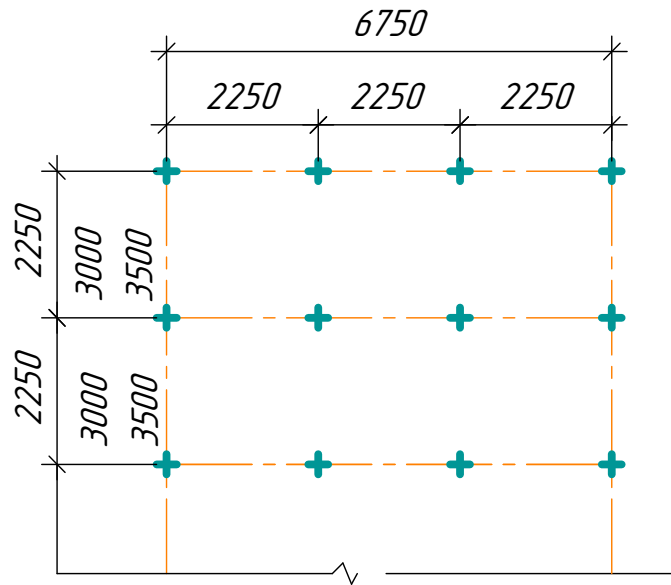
Схема плана свайного поля (точное расположение свай определяется расчетом)
